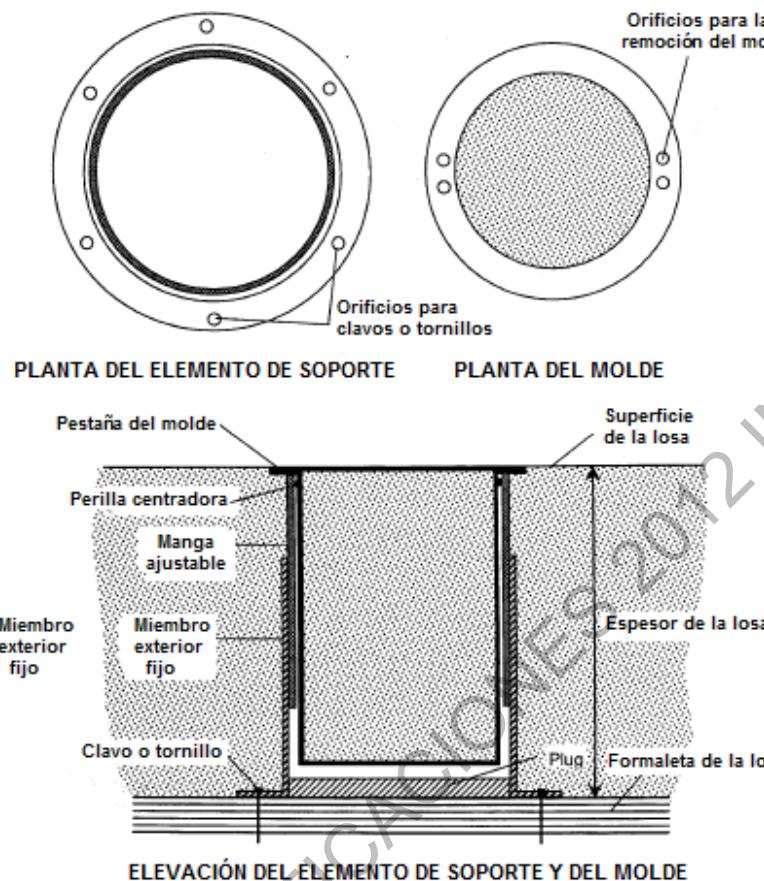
1. Esquema del ensamble del molde para fundir cilindros in-situ
